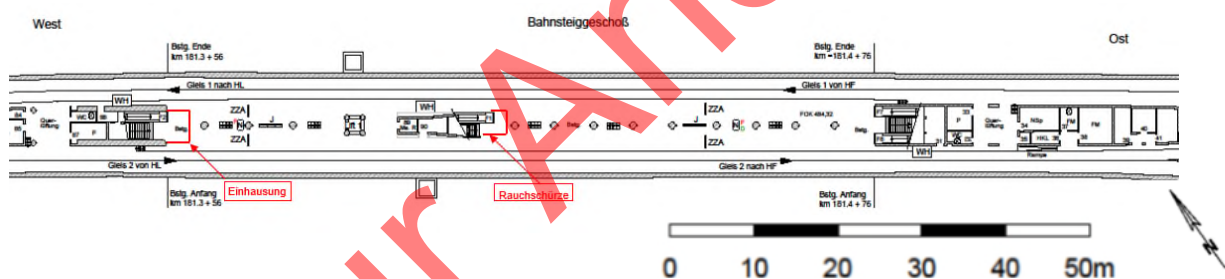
Grundriss Bahnsteiggeschoß, Einhausung/Rauchschürze
